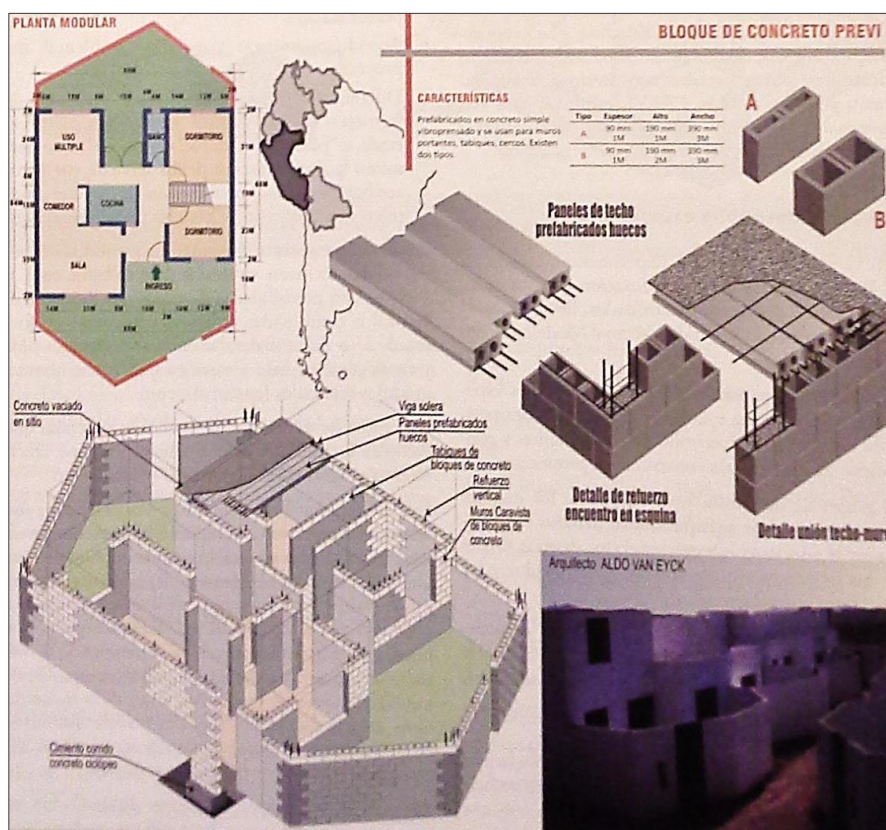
Albañilería armada. Proyecto del equipo Holandés
